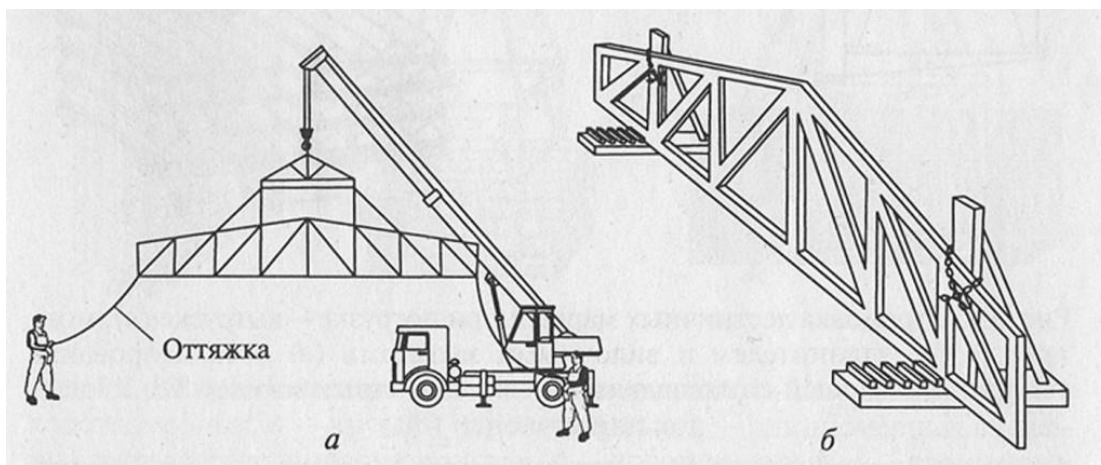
Стropовка (а) и складирование ферм на металлических опорах (б)
